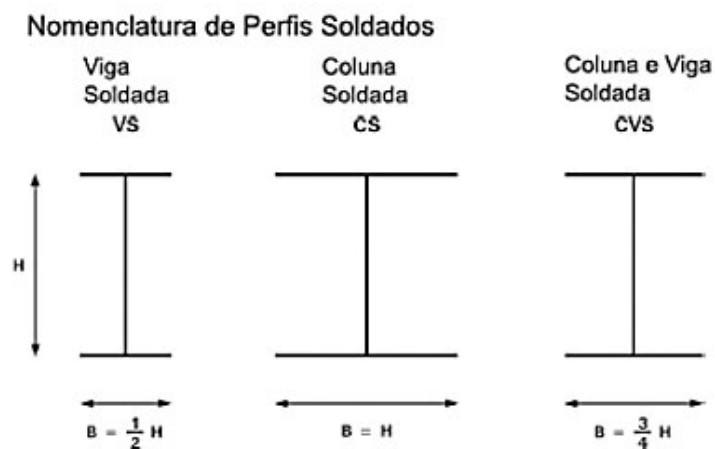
Nomenclatura dos perfis soldados em seção I
